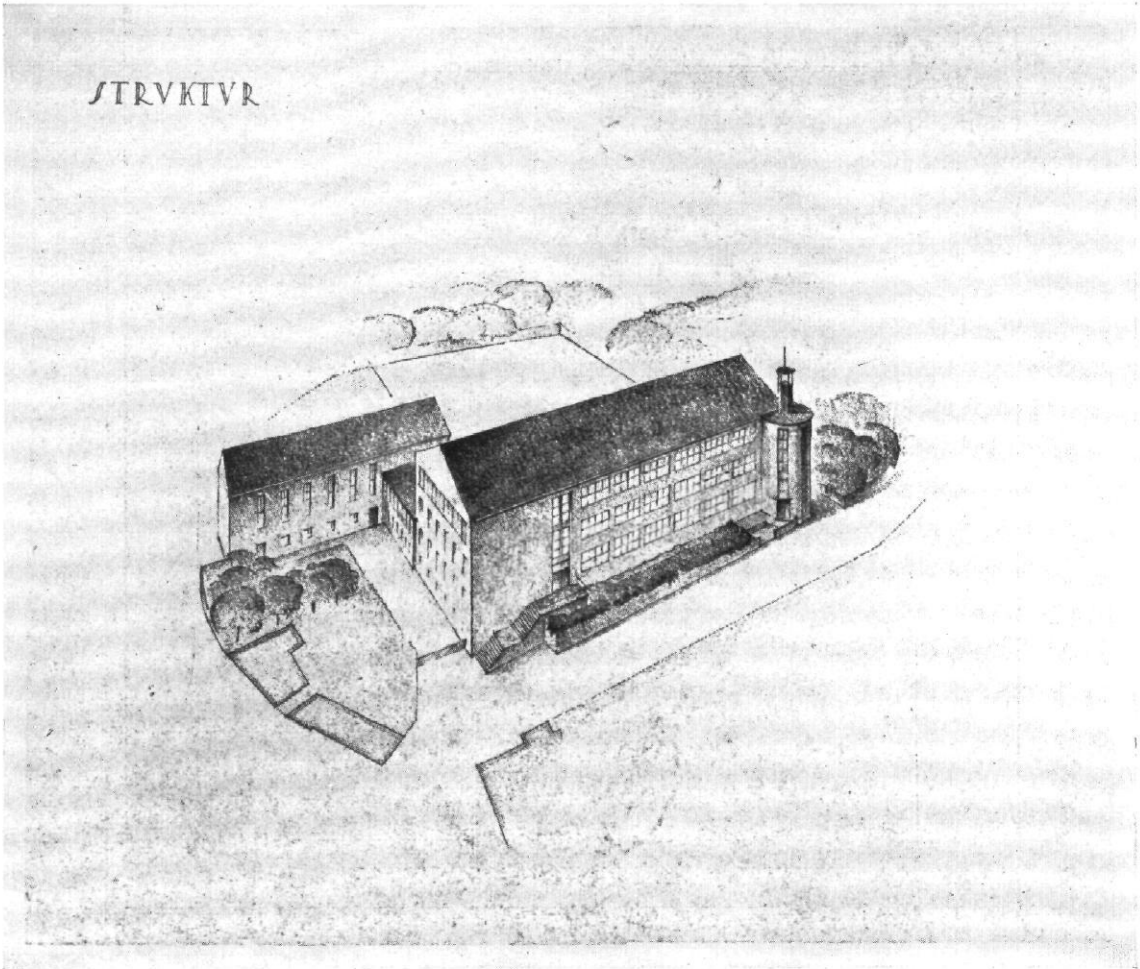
| Wettbewerbsentwurf für eine Schule und Turnhalle in Soest | Architekten: Baurat Wilh. Tiedje u. Albrecht Goethe, Köln
